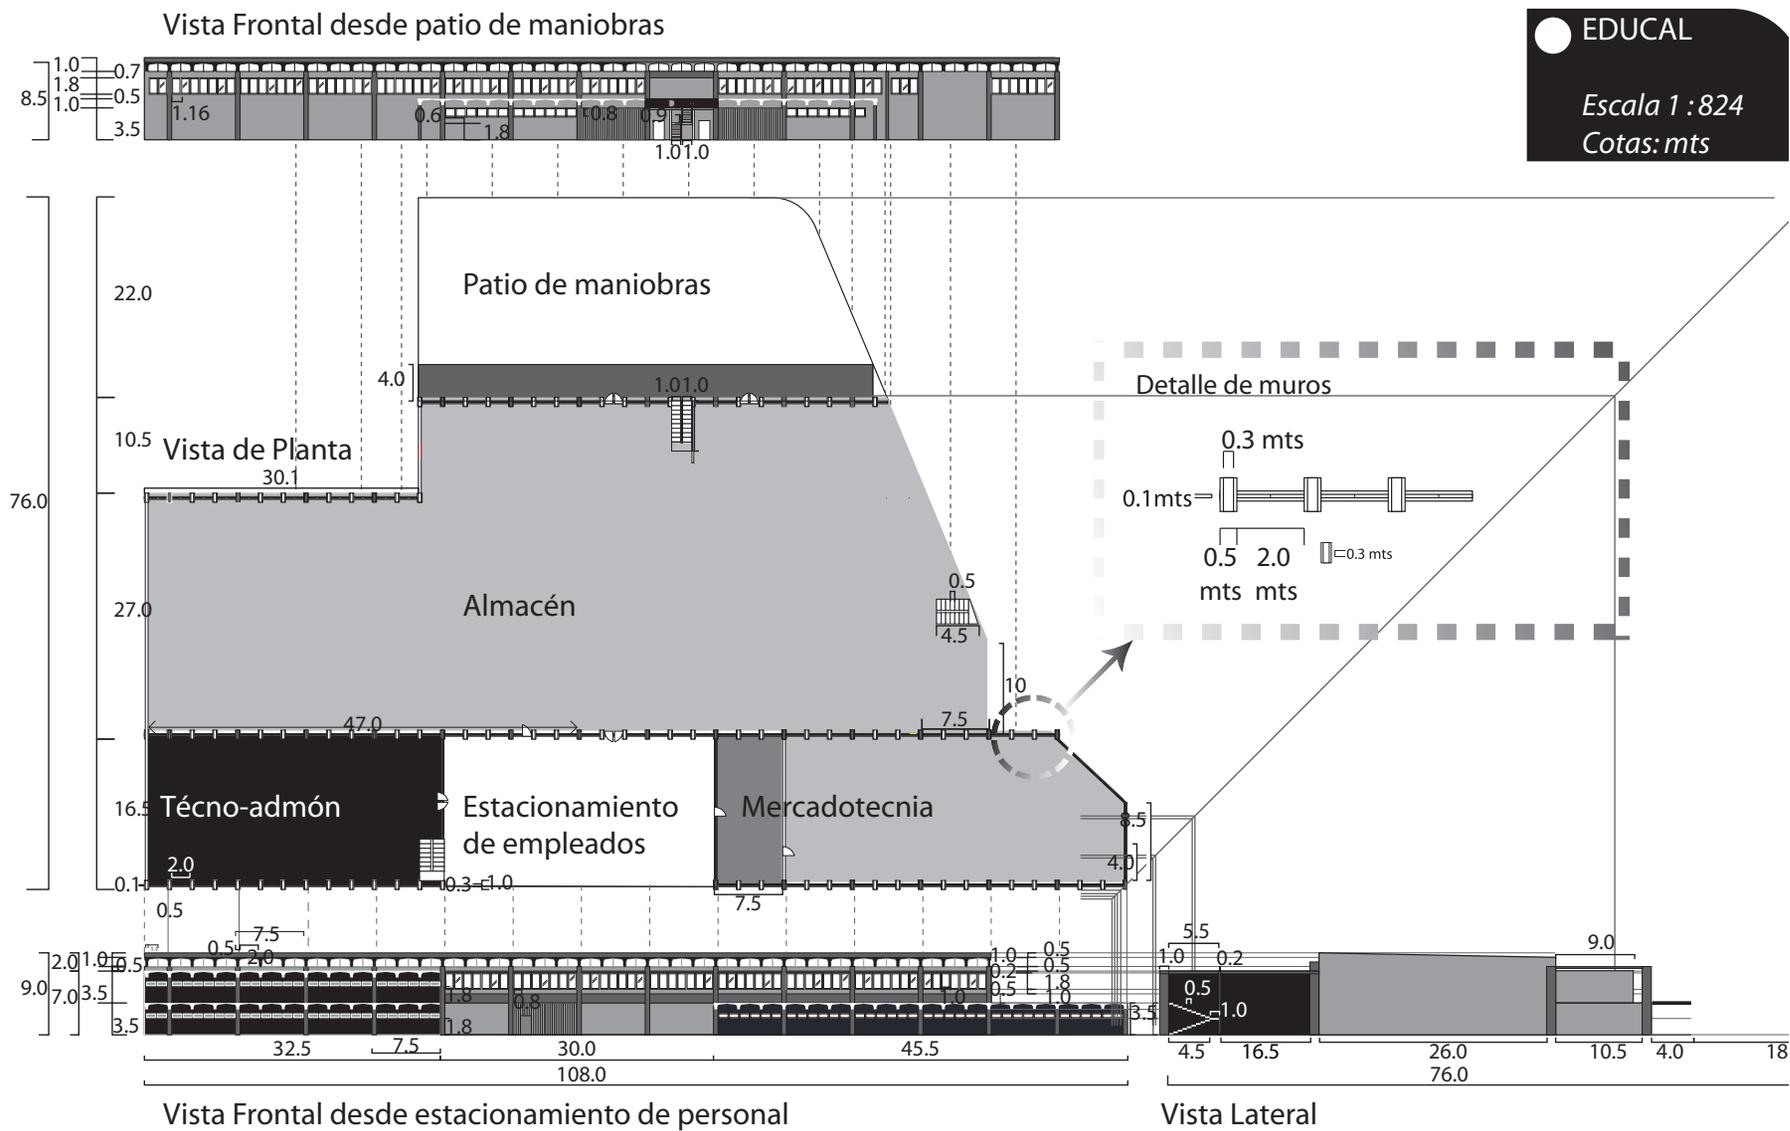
Plano general de las instalaciones de EDUCAL en planta, frente y lareral.
